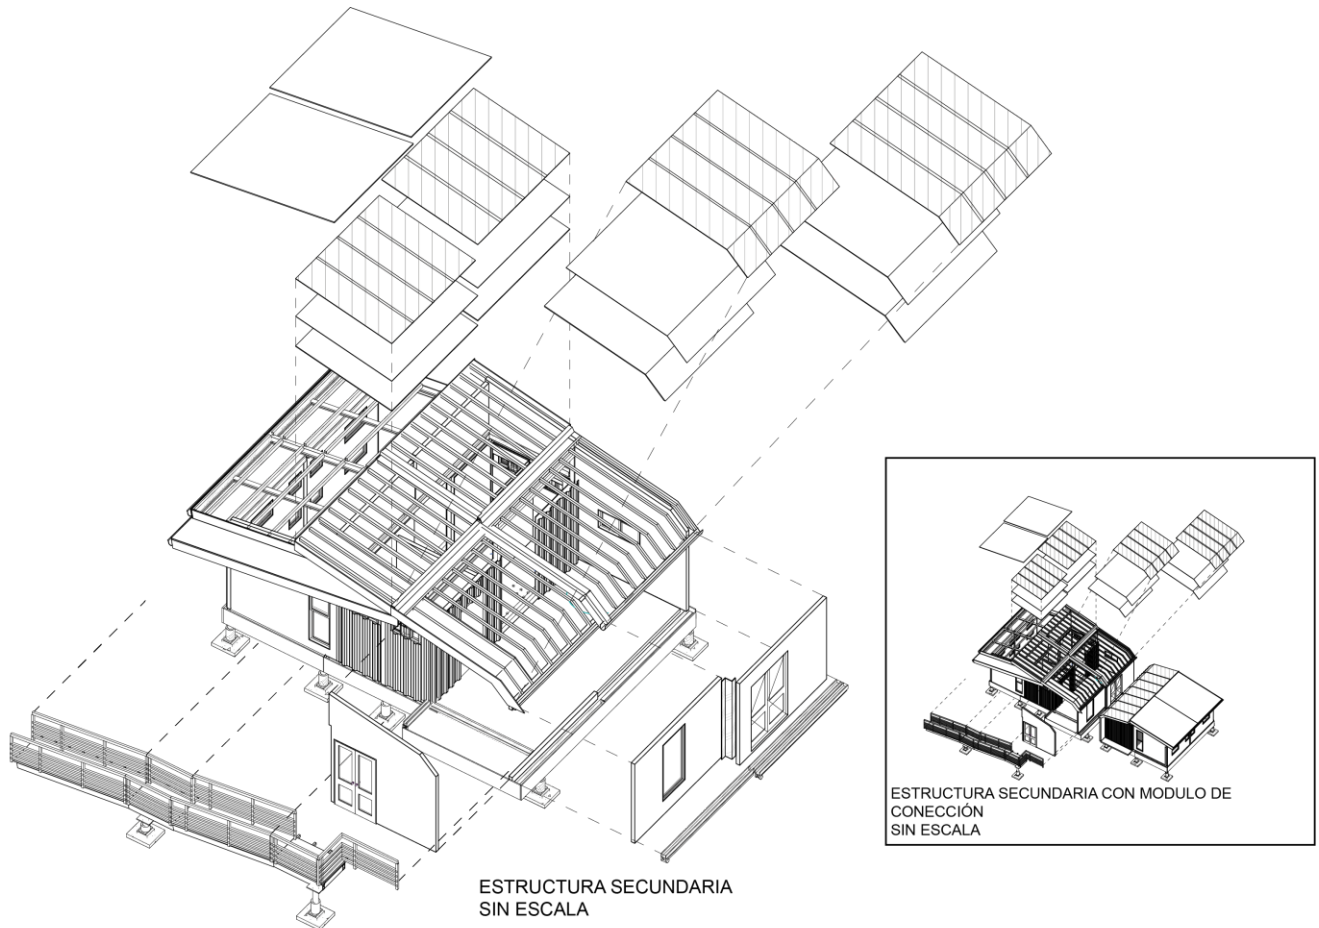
Estructura Secundaria. Elaboración Propia.
